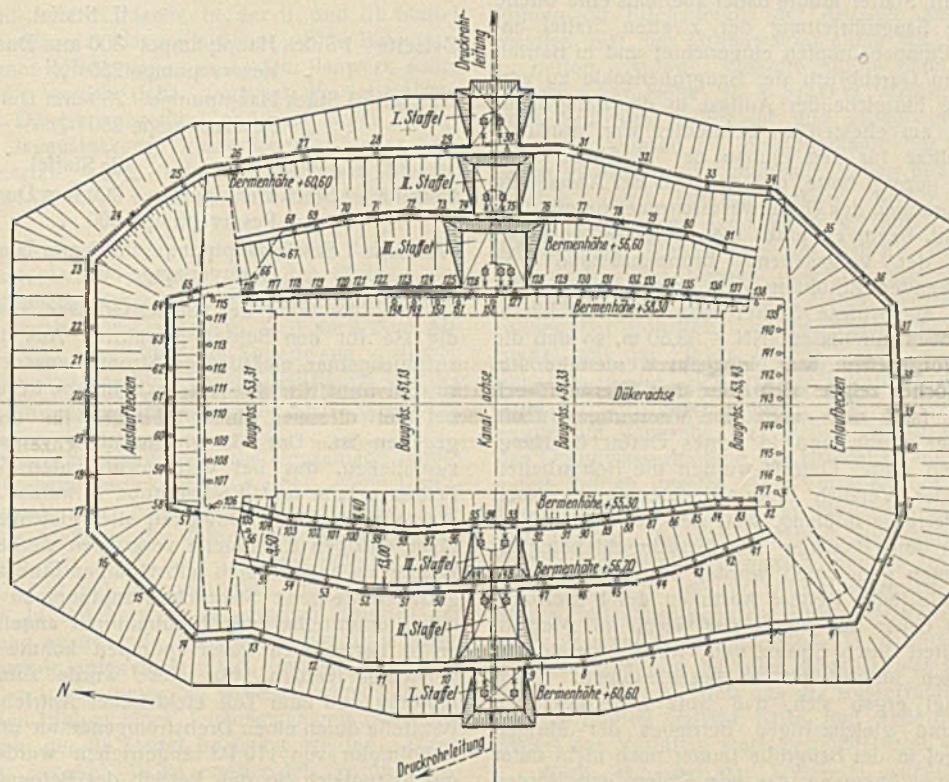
Lageplan der Grundwasserhaltungsanlagen.
